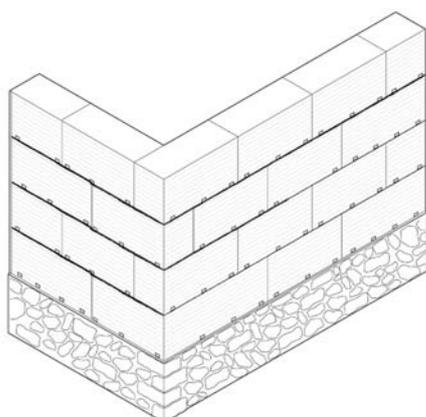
Rejuntado con cemento de un muro de tapia.
